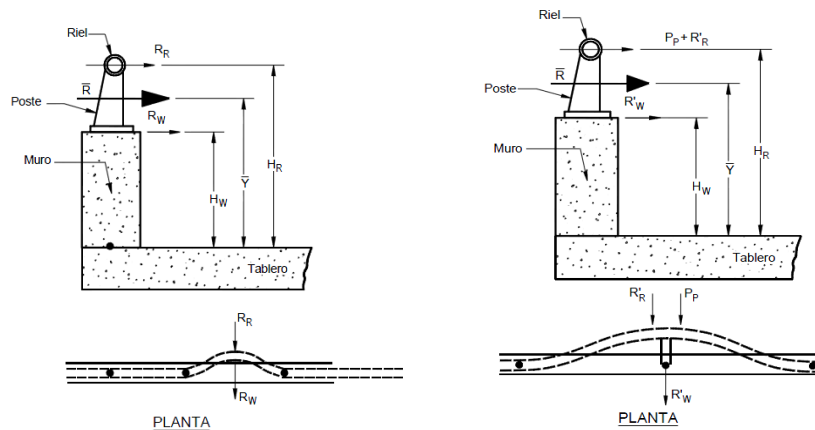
24 Muro de hormigón con riel metálico: Impacto a la mitad y en el poste [2]
